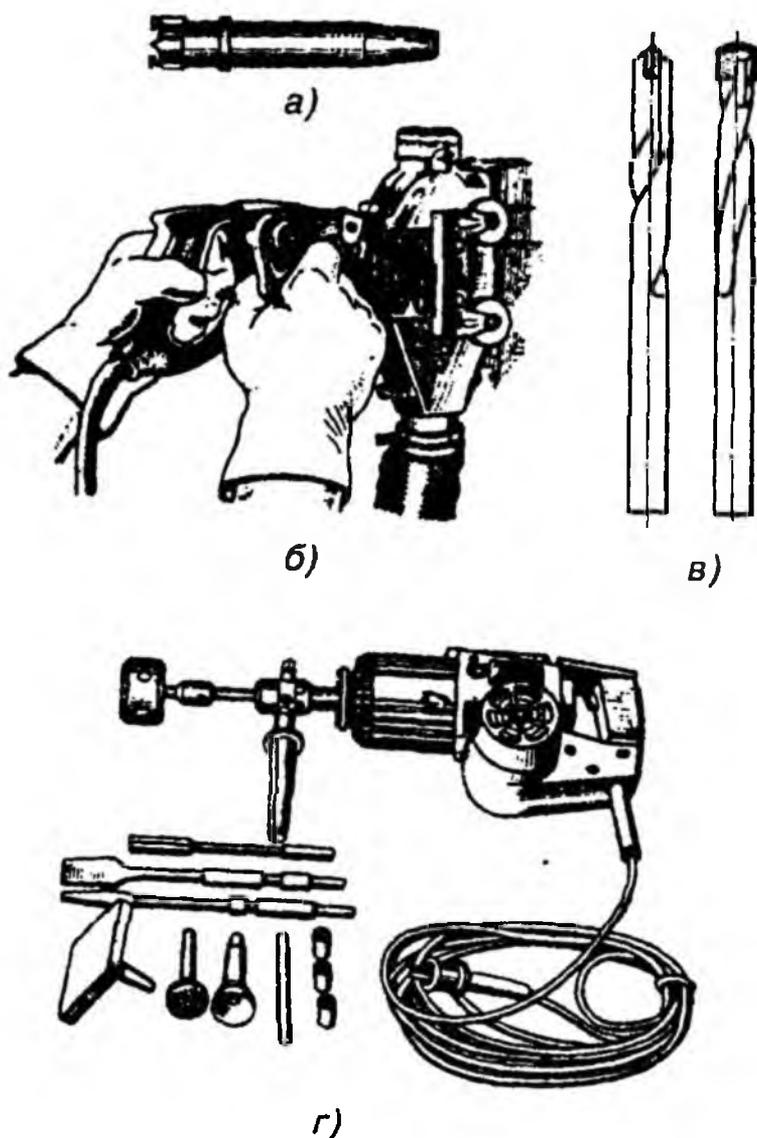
Инструмент, механизмы и приспособления для пробивных работ:
